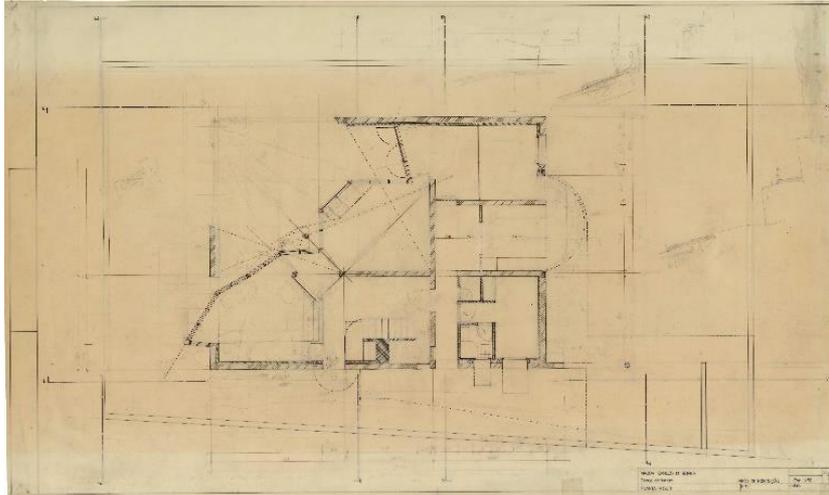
Planta do Piso 1 da Casa Beires. Esc. 1/50. Fonte: Arquivo Arqtº Álvaro Siza. Col. Fundação de Serralves – Museu de Arte Contemporânea, Porto. Doação 2015.
